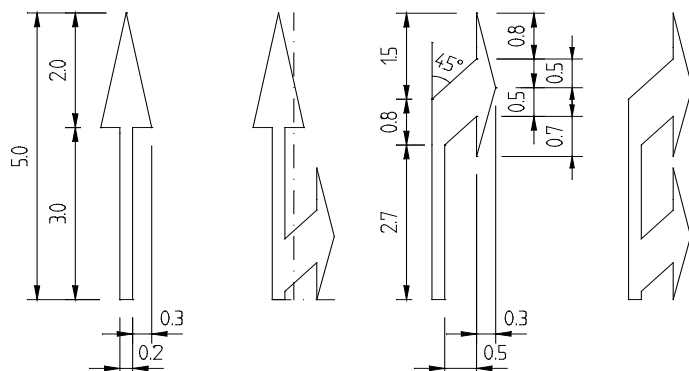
Körfältspilar och pilar i ramp för att förhindra spökkörning
